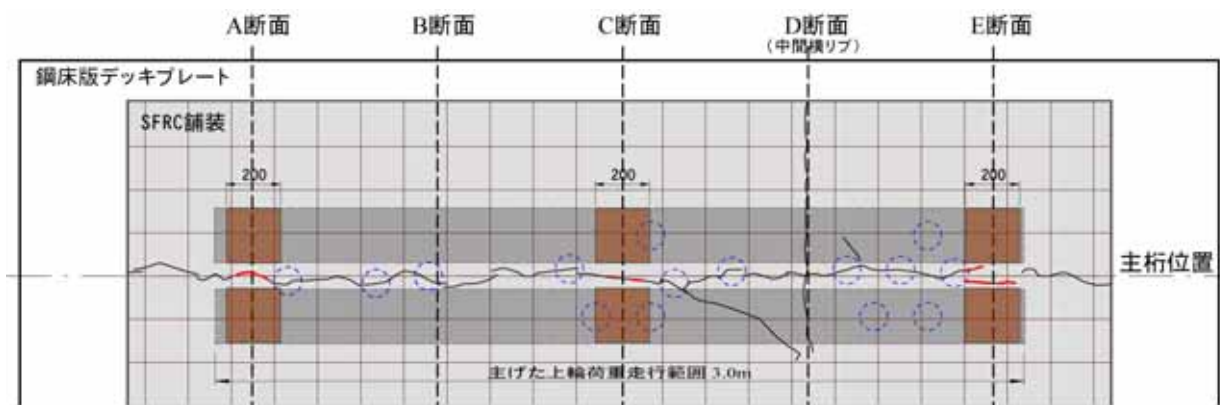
輪荷重走行後のひび割れ状況 (試験体 No.1)
